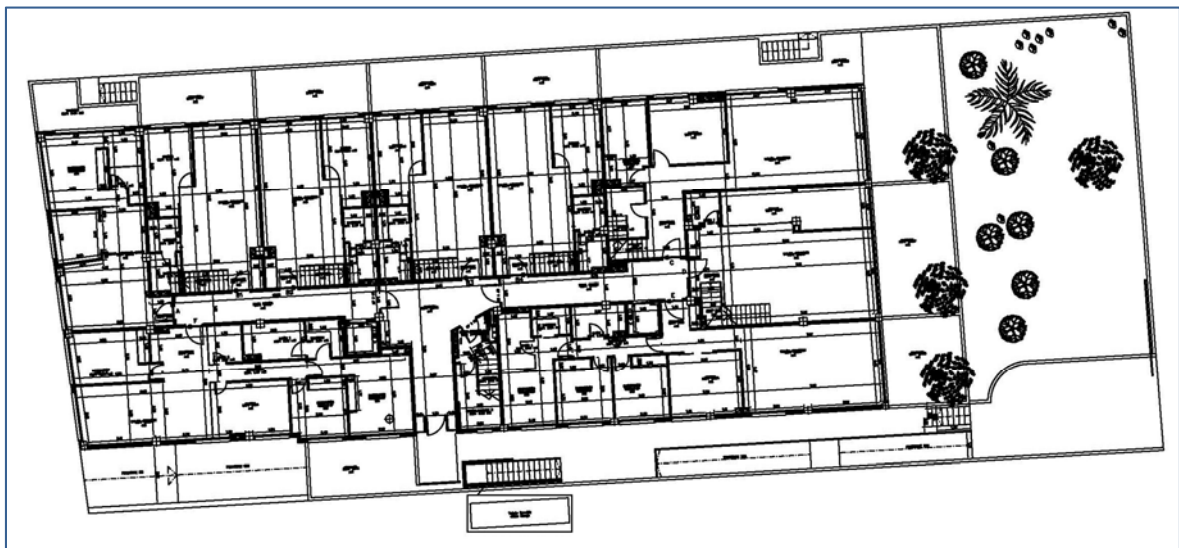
Plano de planta baja. Procede del Proyecto de Ejecución.
